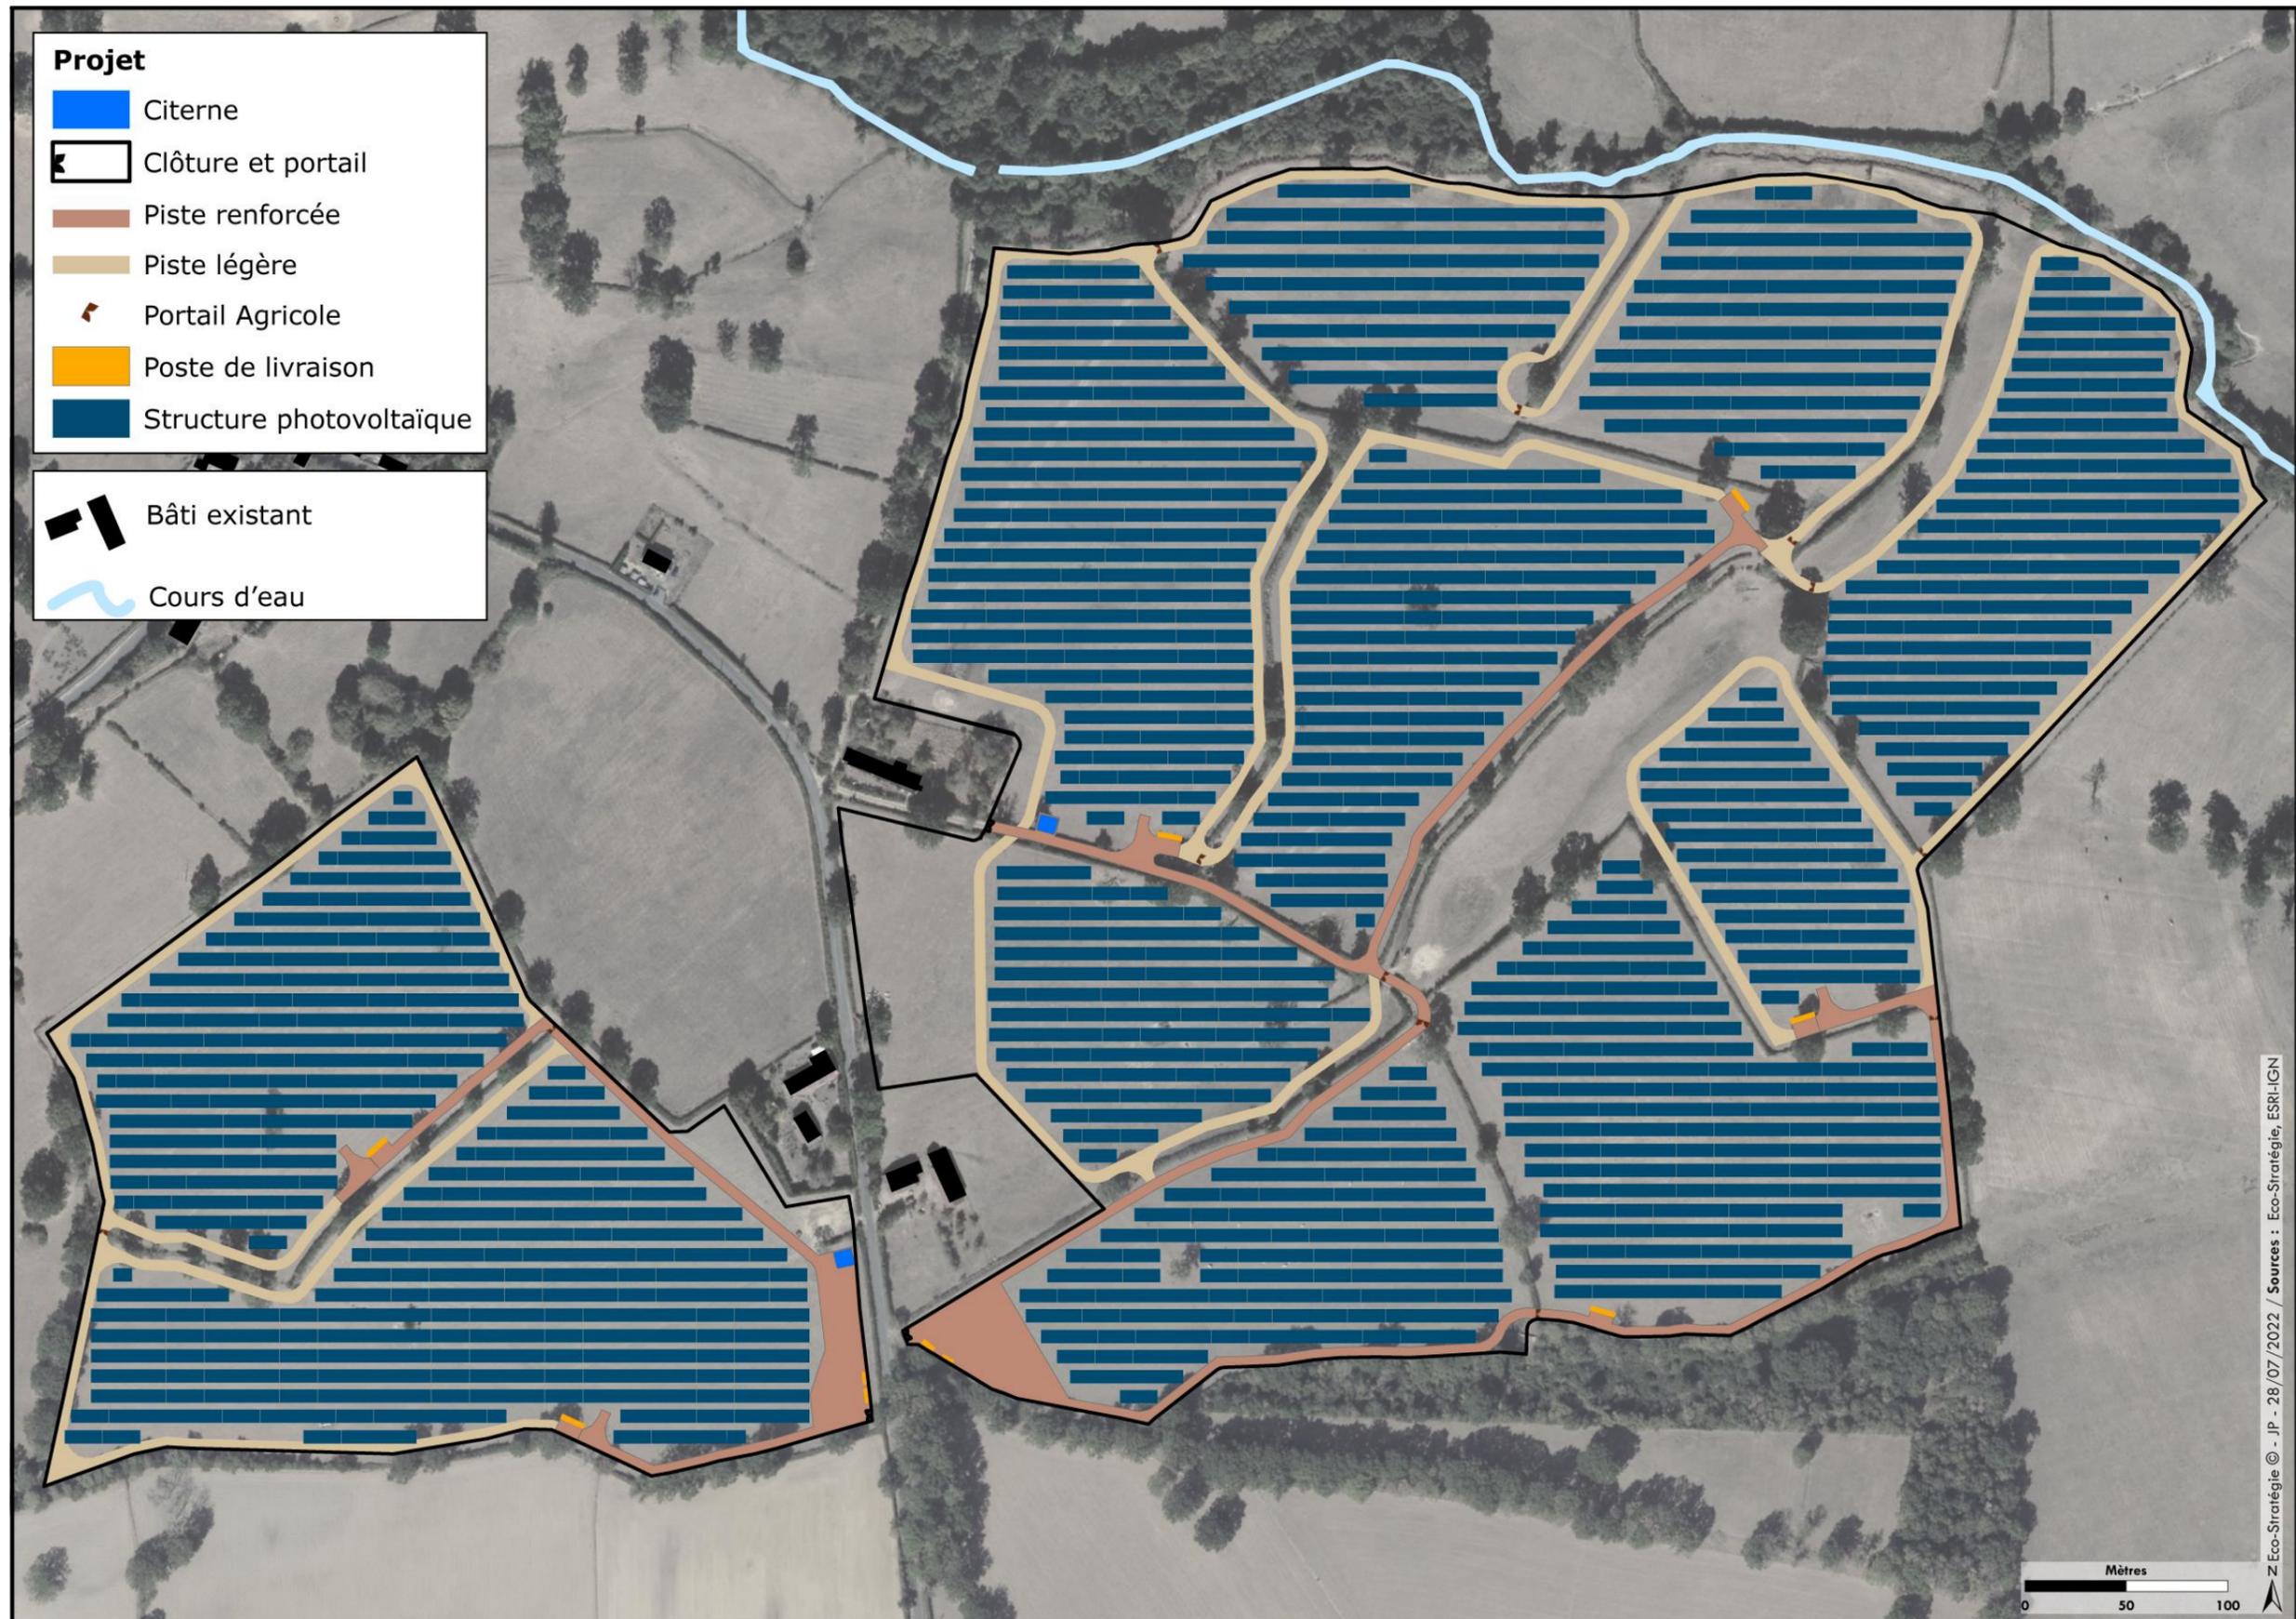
Plan de masse du projet de centrale au sol de Voussac
